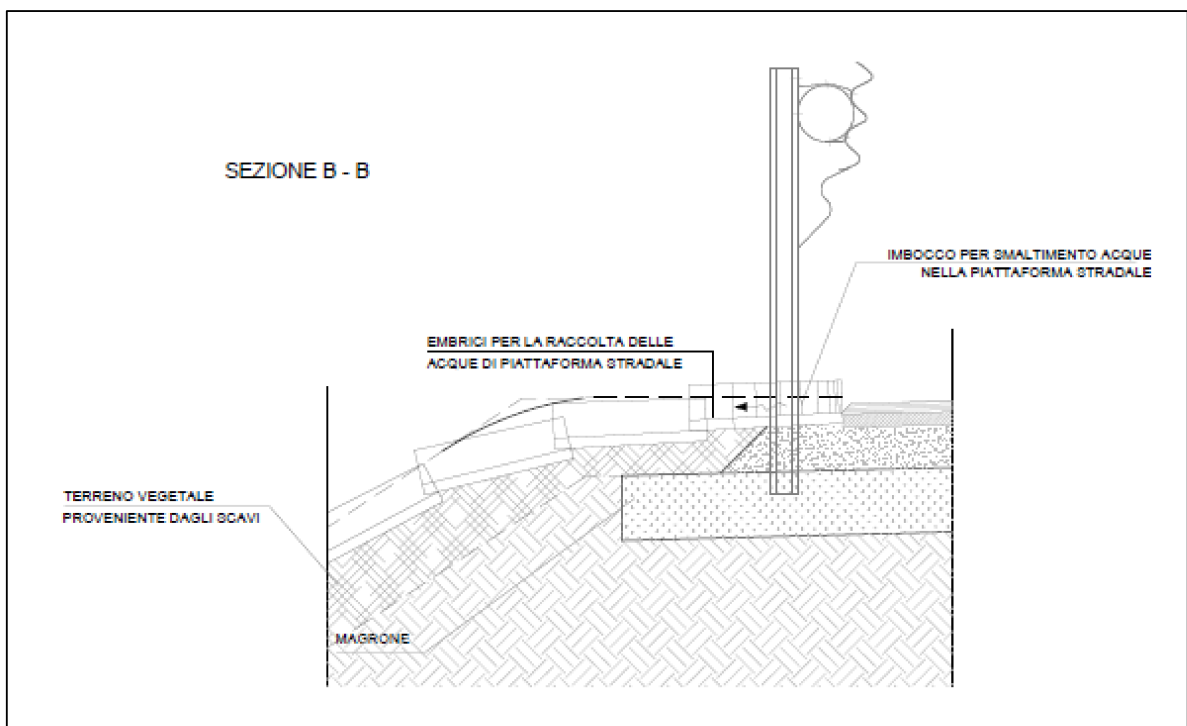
Schema del drenaggio per sezione in rilevato - Embrici
